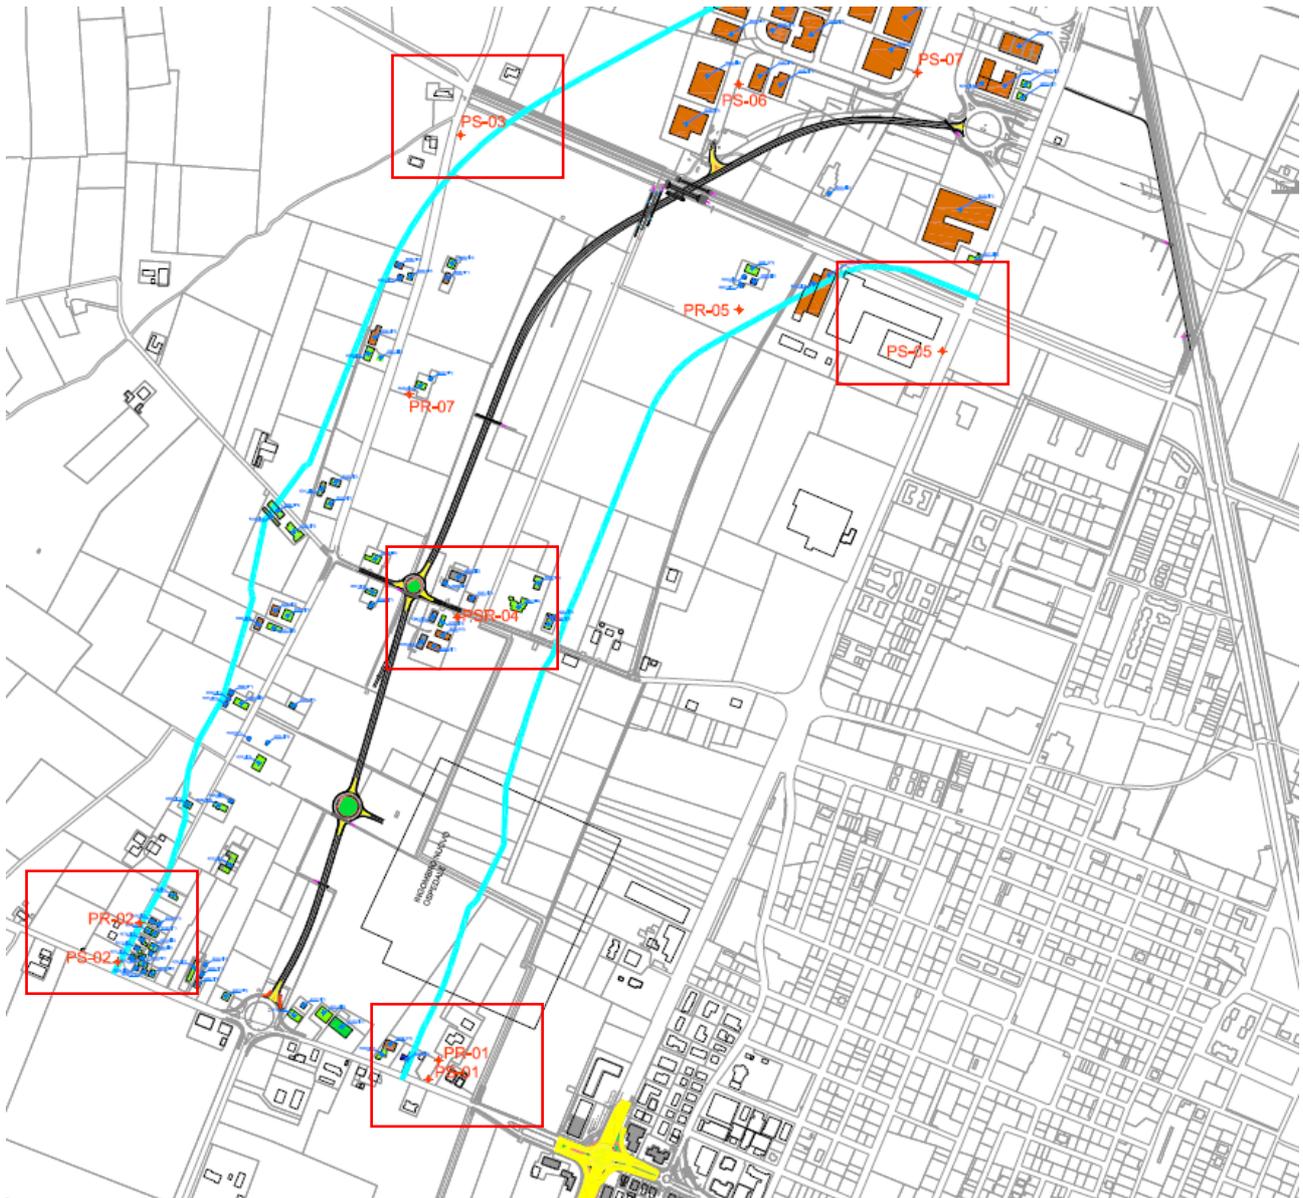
Localizzazione planimetrica delle postazioni di misura indagate per il progetto della nuova Bretella ovest - tratto di completamento
